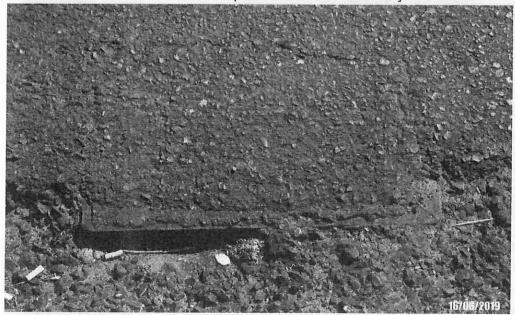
Detalhe da caixa de Instalação elétrica exposta no pavimento.
